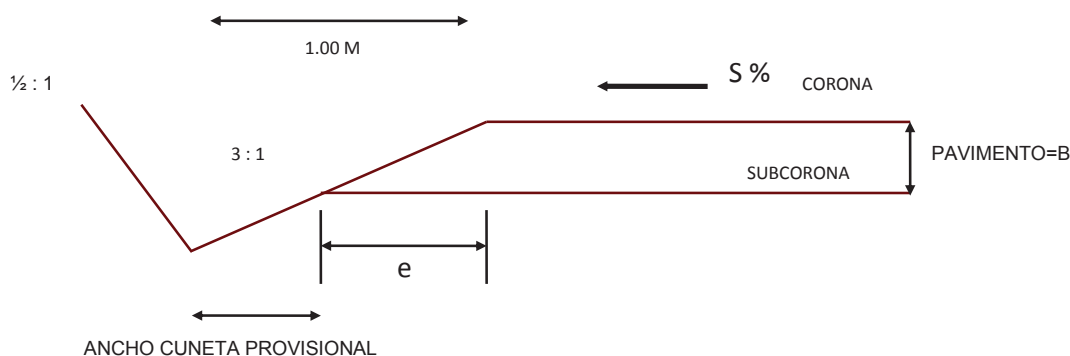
Corte Transversal de una sección tipo para cuneta
